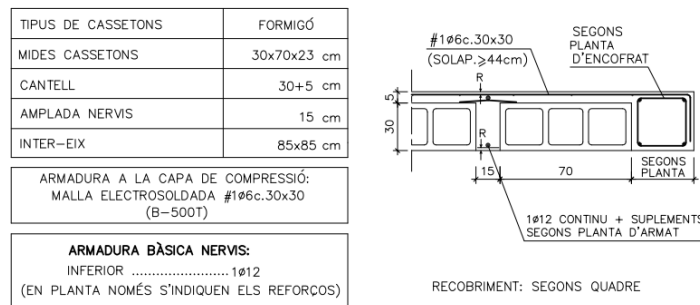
Características de la losa nervada de 35 cm (Fuente: Planos estructurales del edificio K2M)
